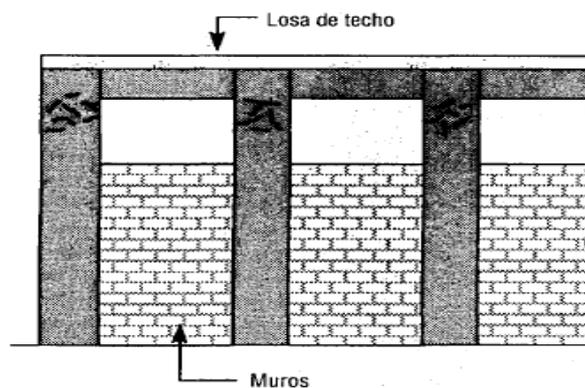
FISURAS - ROTURAS EN CABEZA DE COLUMNA CORTA
